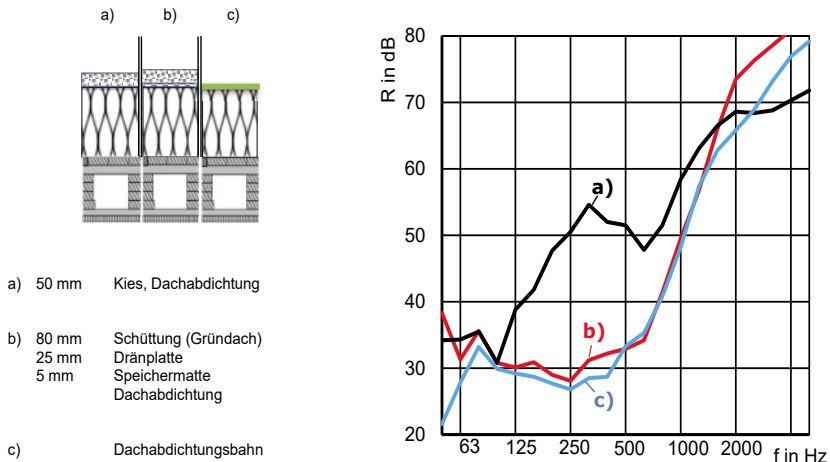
Vergleich der Aufbauten: Kiesdach, Gründach und einfache Dachabdichtungsbahn auf einem Brettsperrholz – Kastelement mit 200 mm EPS-Aufdachdämmung
